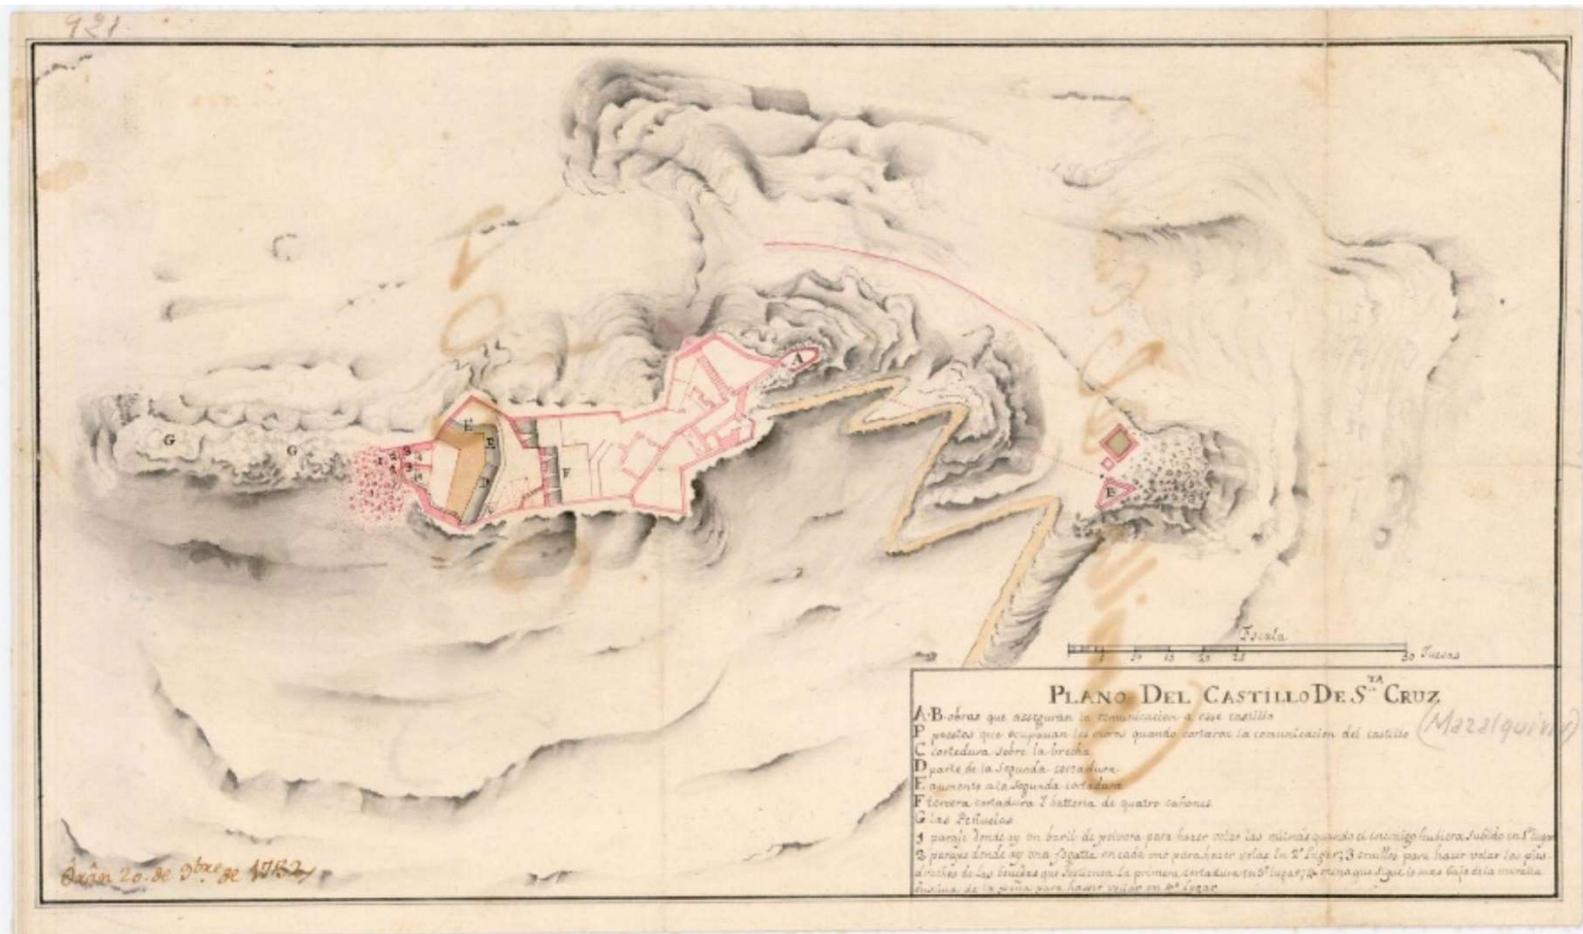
Plano que muestra la brecha de Santa Cruz en 1732 (SGE. 108°).
